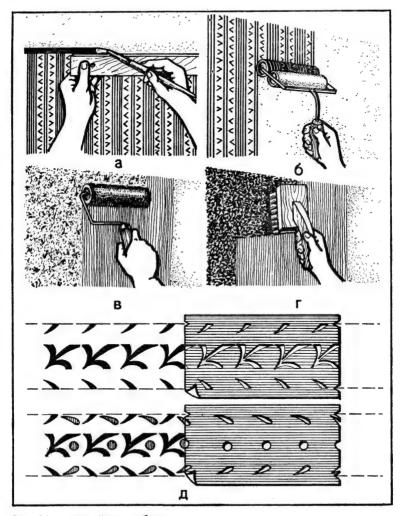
Альфрейные работы: а — вытягивание филенки; 6 — накатка валиком; в — разделка поверхности с помощью мехового валика; г — разделка поверхности жесткой щеткой; д — набивка рисунка с помощью трафарета
